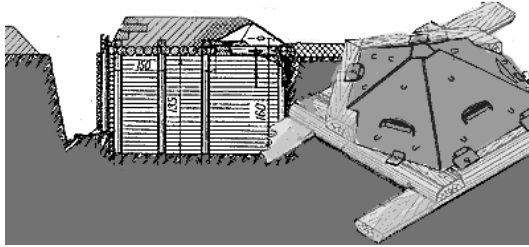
Спостережний пост з траншейним броньованим перекриттям і оглядовими щілинами
